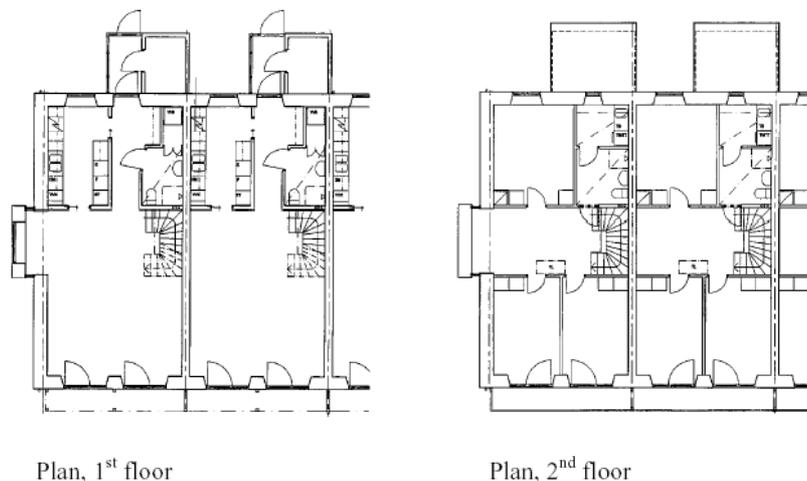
Gebäudegrundriss Reihenhaus (Smeds et al., 2002)
